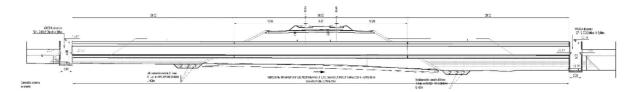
Attraversamento pk 31+293 – Sezione Longitudinale
